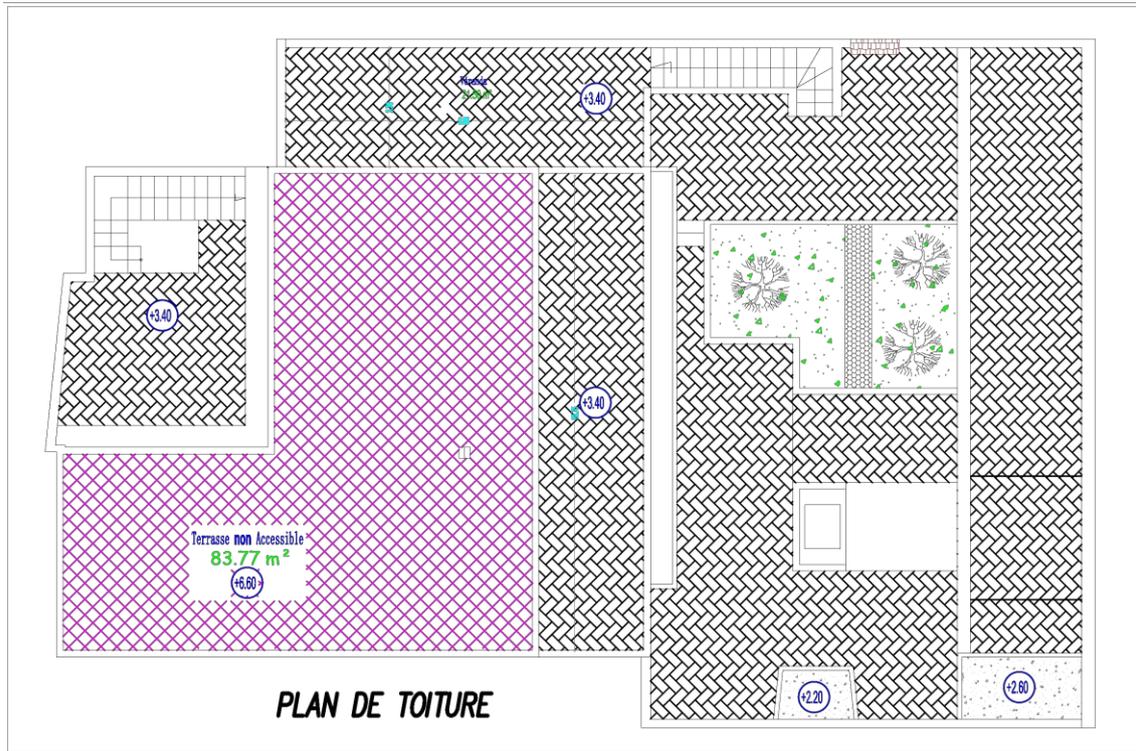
Plan de toiture –modèle N° 02- (Source : Auteur)
